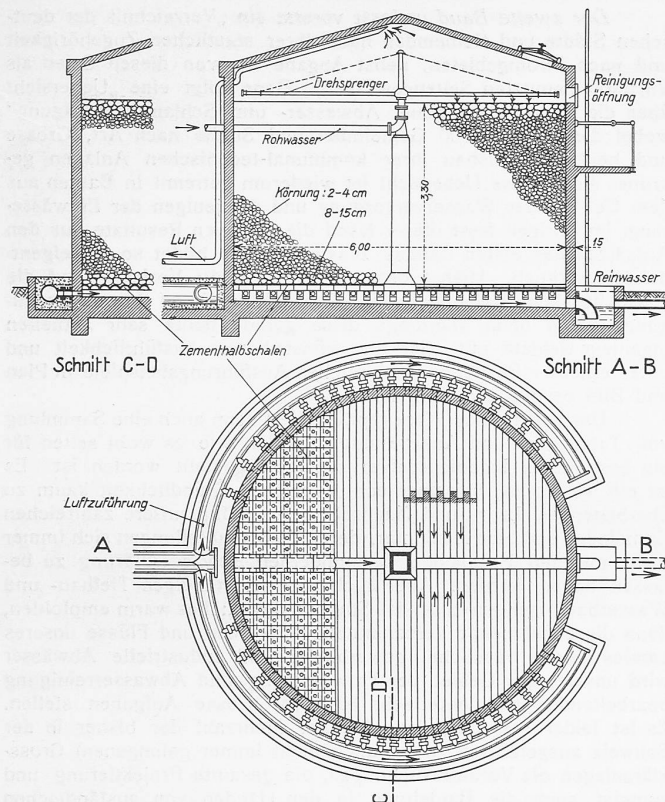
Geschlossener, belüfteter Tropfkörper. Grundriss und Schnitt, 1:125.
